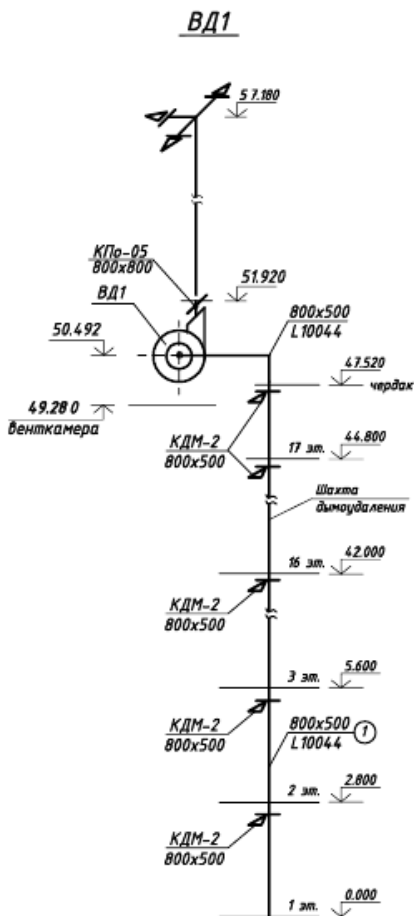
Противодымная вентиляция коридоров 17-этажного здания
